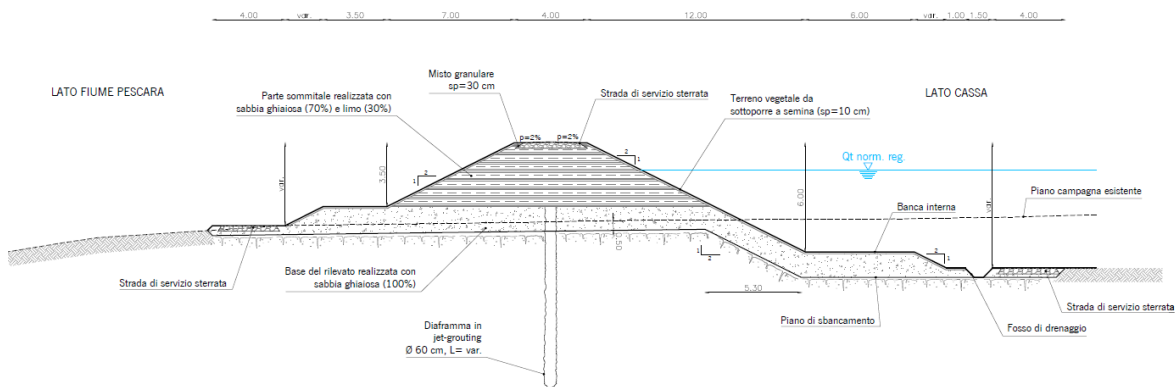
Sezione tipo di rilevato arginale con presenza del diaframma.
